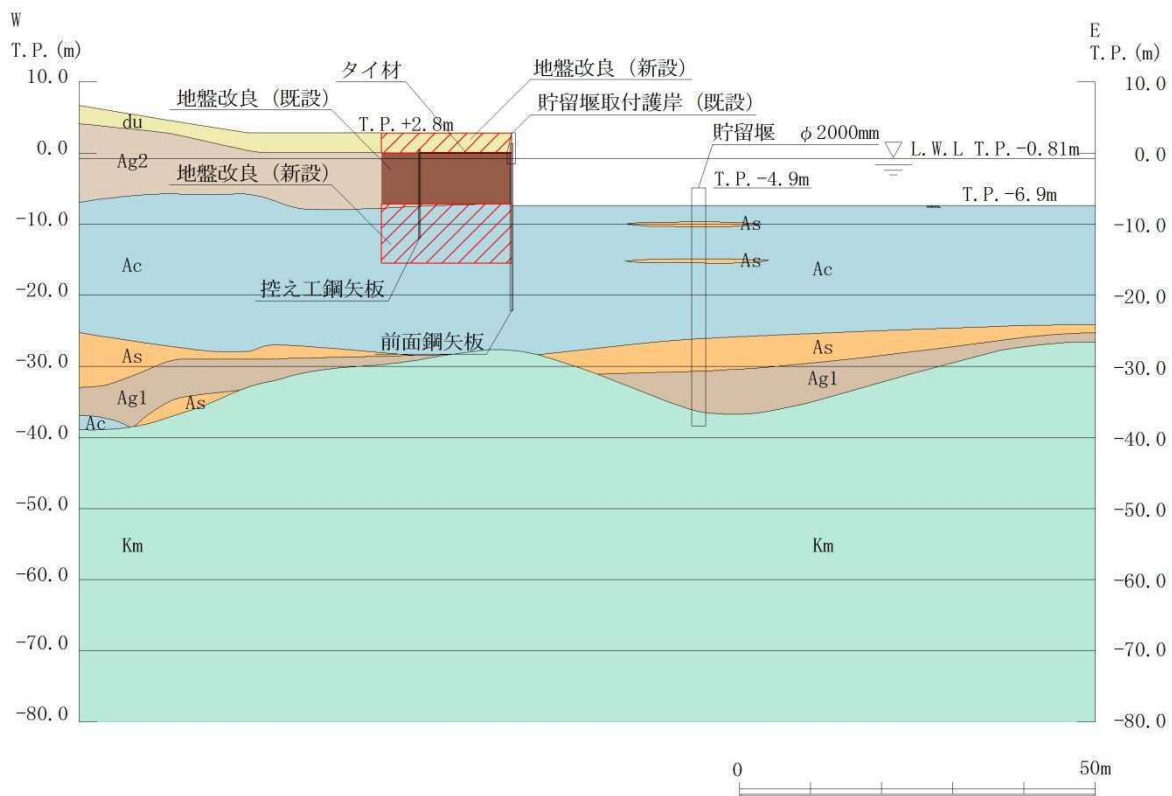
(3) 貯留堰及び貯留堰取付護岸の断面図 (EW-3)
